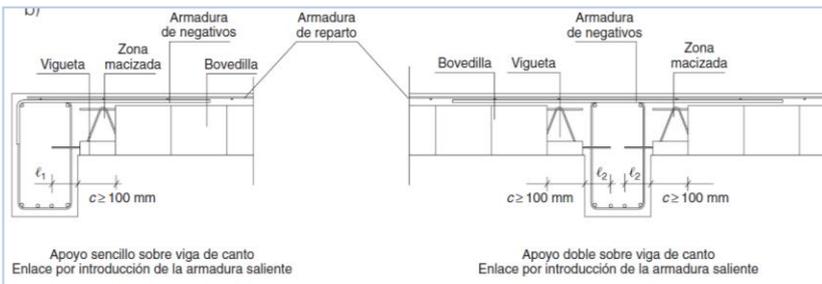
y 16. Apoyo sobre viga de canto. Enlace por introducción de la armadura saliente
